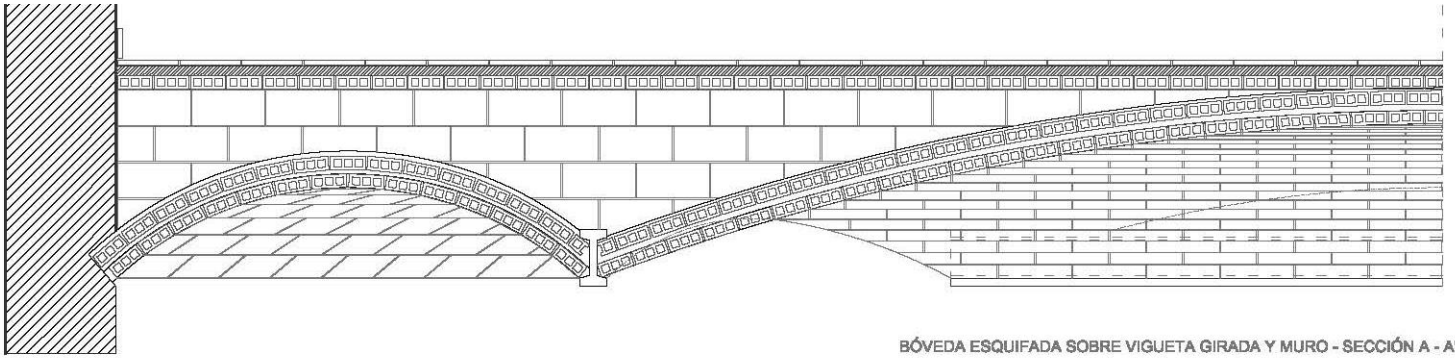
Bóveda rebajada de piso con zuncho metálico girado. (Guastavino, 1893, pág. 126)
